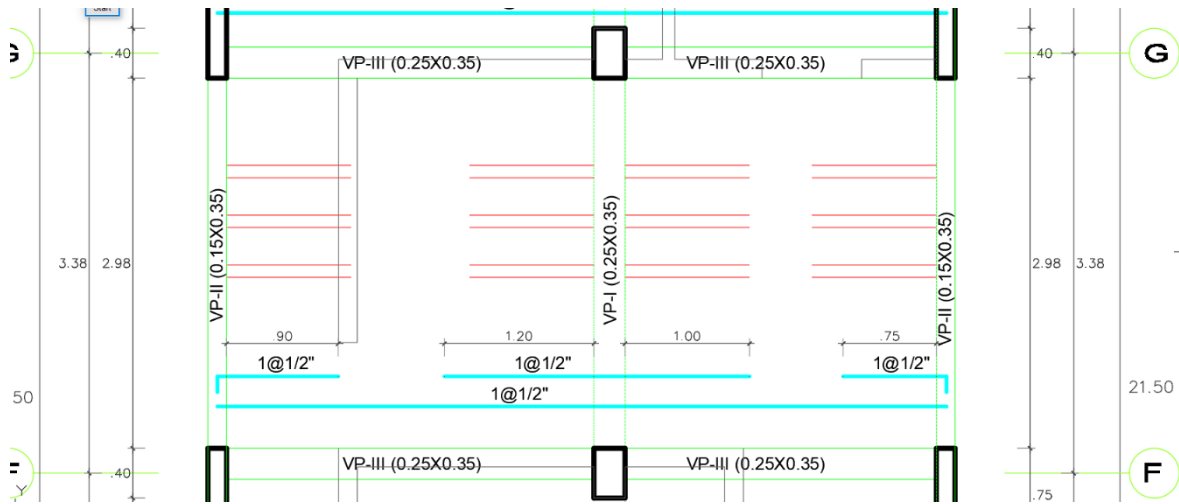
Refuerzo de losas aligeradas en una dirección paños continuos.
